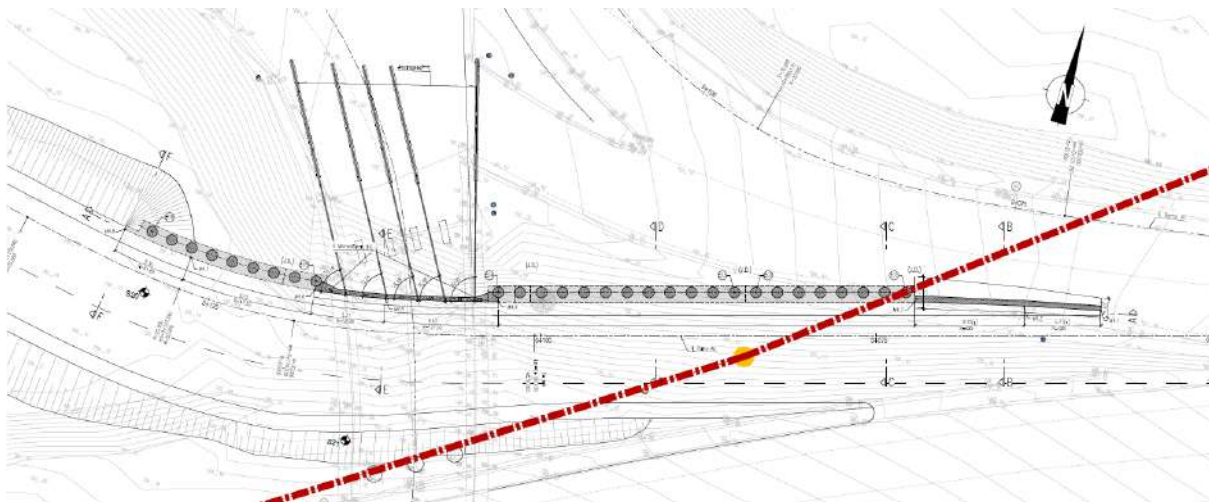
Planta de localização de serviços de saneamento junto do muro M4.
